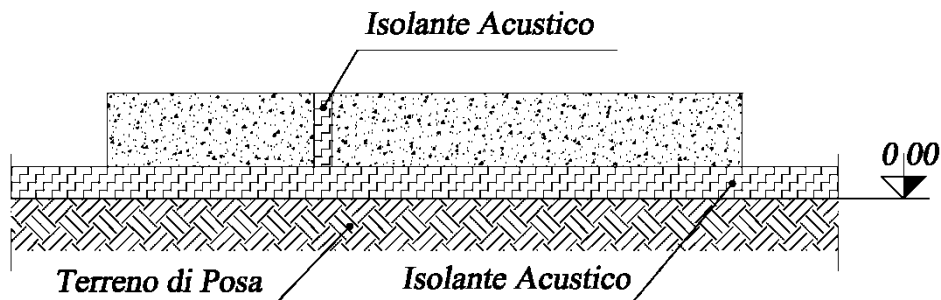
Sezione C-C della lastra di calcestruzzo (Monteforte, 1998).
